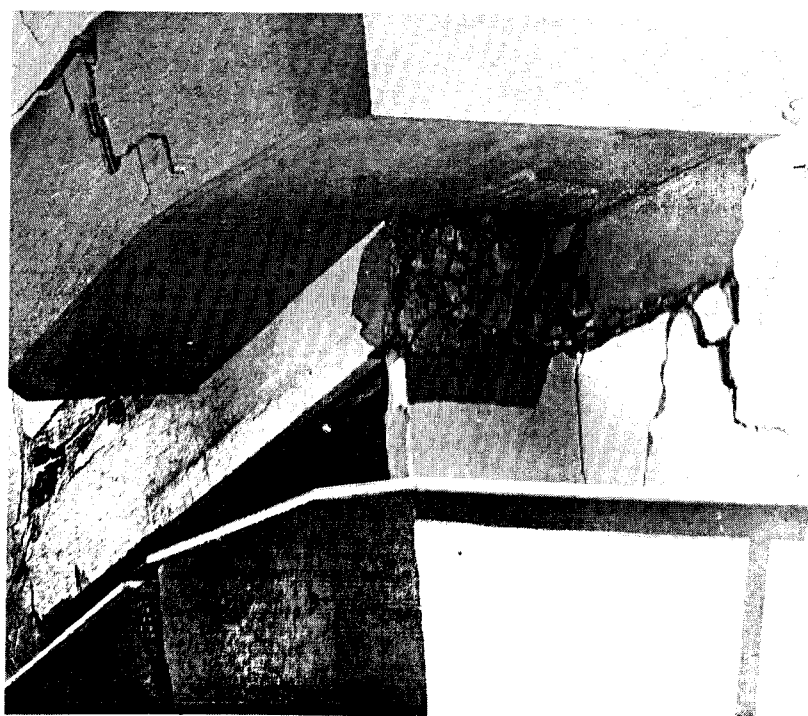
Degradación de un nudo de viga-columna y articulación de la estructura.
